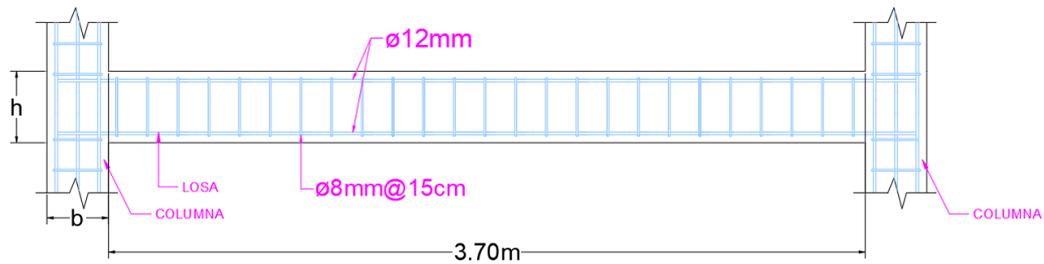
Detalle de viga principal de losa en plano estructural [AutoCad]
